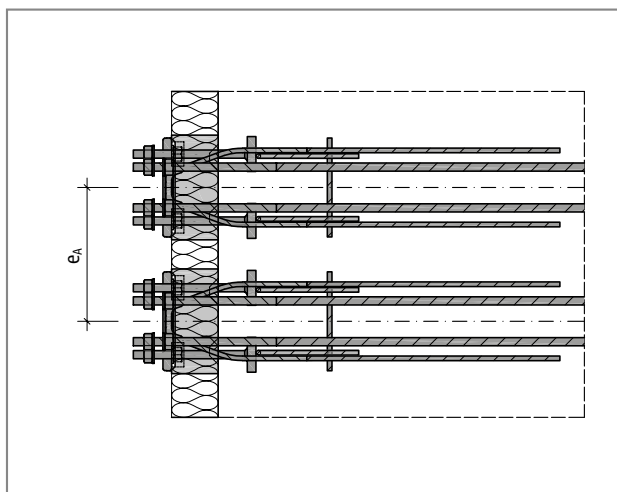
Schöck Isokorb® T tipo SKP: distanza assiale
